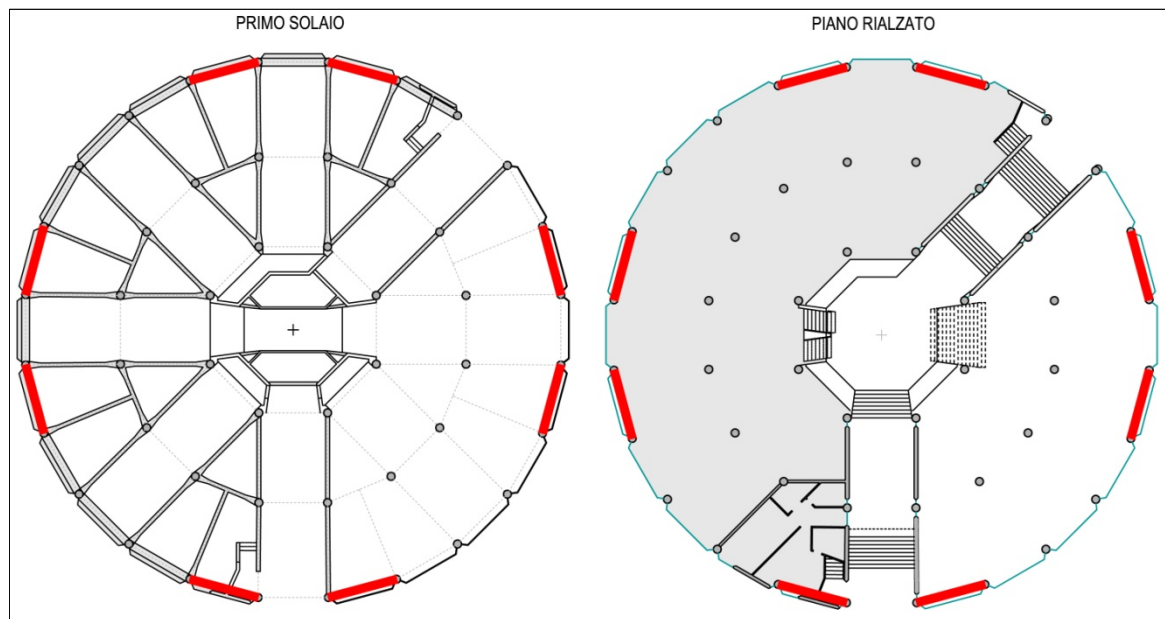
pianta strutturale ed architettonica del primo solaio con rappresentazione degli interventi
